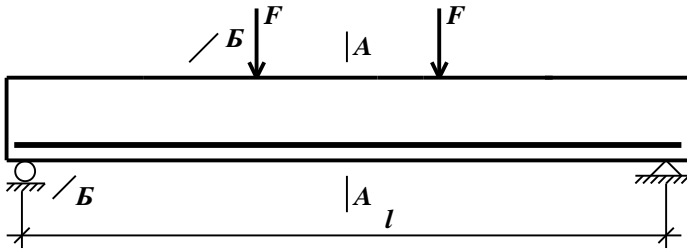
До розрахунку на міцність згинальних елементів довільного симетричного профілю: схема навантаження залізобетонного елемента; А-А – нормальний переріз; Б-Б – нахилений до осі переріз
